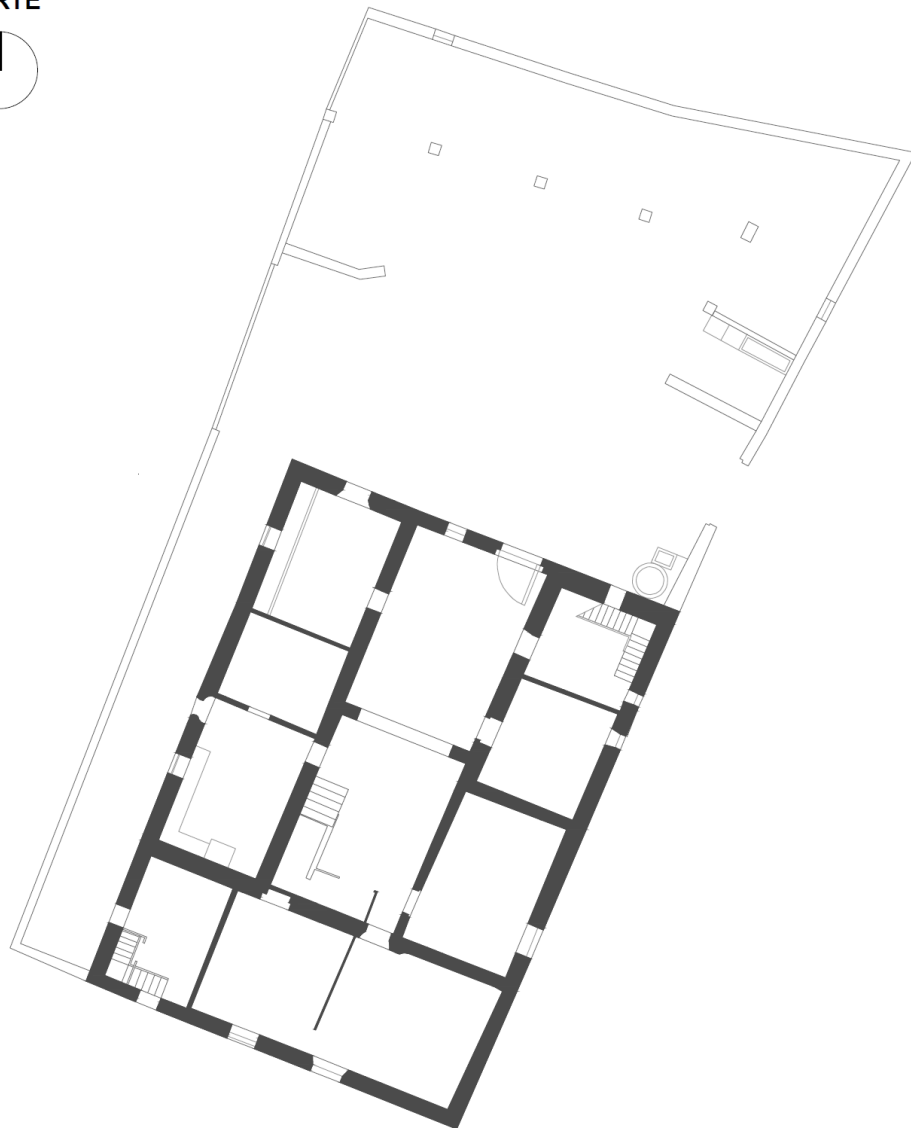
Planta Baja del volumen principal de La Alquería del Moro. Escala 1:250. Fuente propia.
